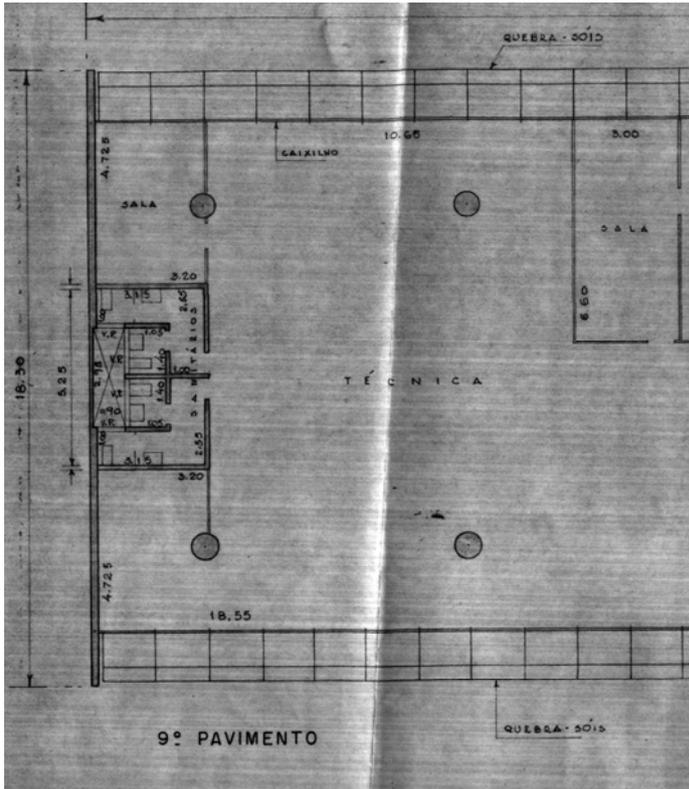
Pormenor da planta do pavimento-tipo, datada de 1961. Acervo digital Rino Levi – FAU PUC Campinas. Observa-se a área entre pilares circulares e os sanitários aproveitadas posteriormente para colocação de sistema de ar-condicionado central e criação de *shaft* no sanitário feminino
